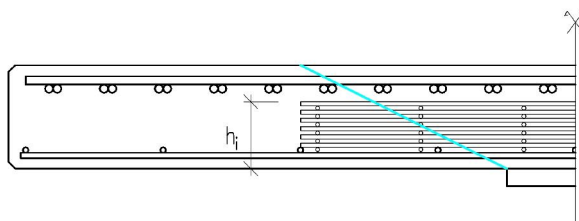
Pormenor das armaduras do tipo malha da laje PBC5.
